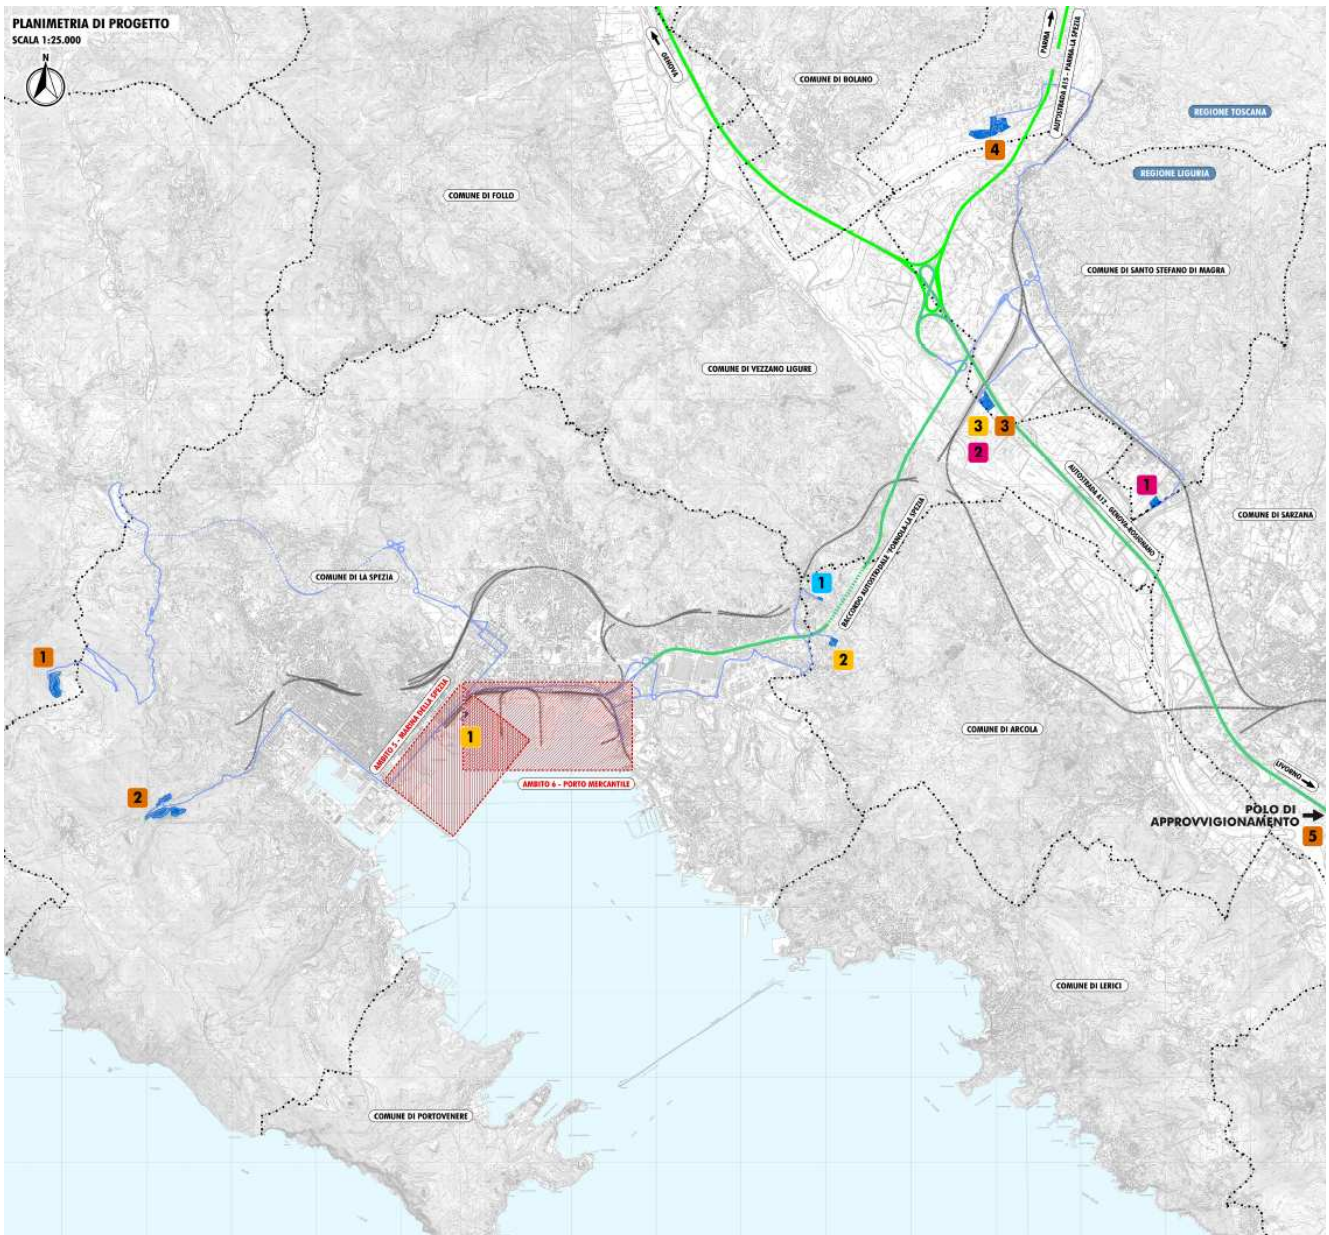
planimetria generale con individuazione dei percorsi di approvvigionamento/conferimento dei materiali (estratto dall'elaborato PP/SPA.02.02 – “*Planimetria generale con indicazione dell'area d'intervento, dei poli di conferimento ed approvvigionamento dei materiali e dei percorsi dei mezzi operativi*”)
